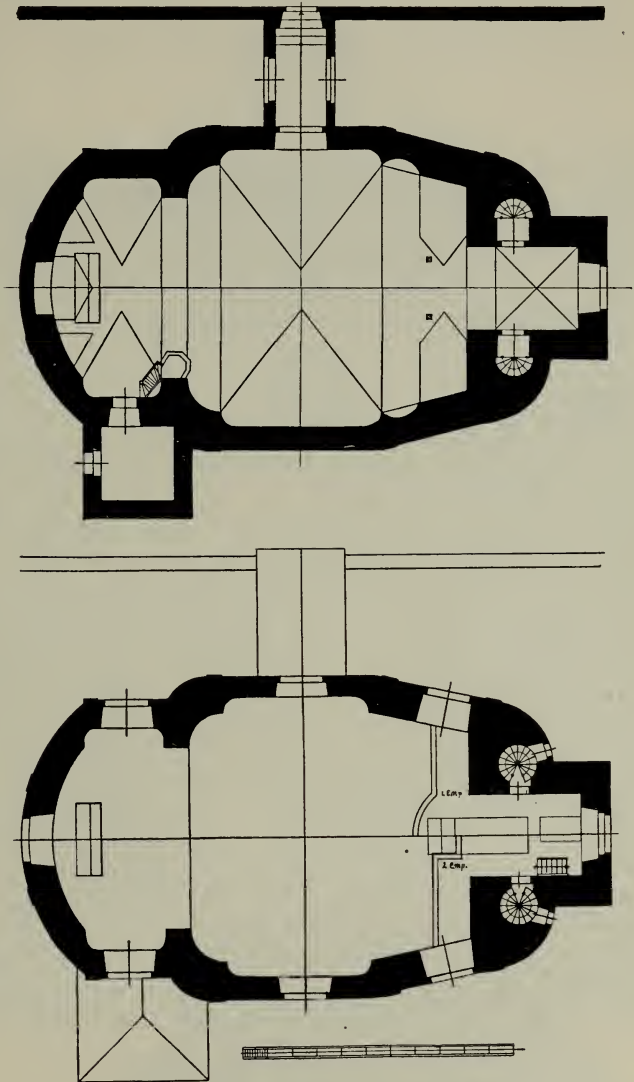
u. 288. Ostro, Kirche, Grundrisse.
